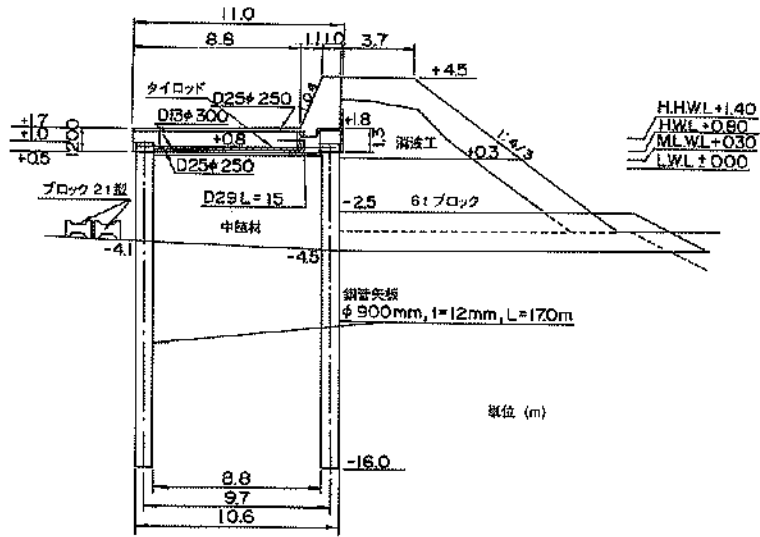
標準断面図 (上磯漁港、①南防波堤)
